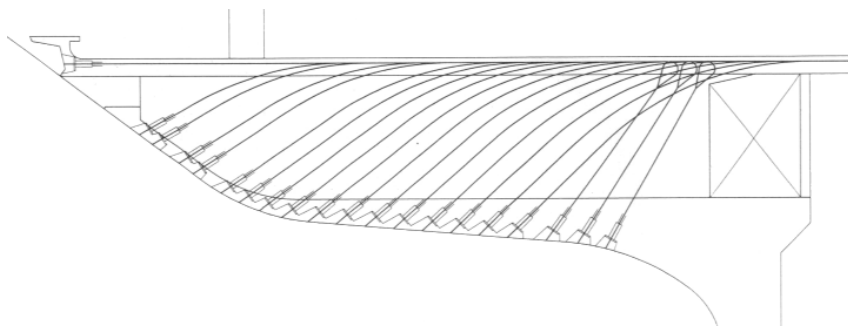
Disposición de las armaduras de postesado de las vigas inferiores
